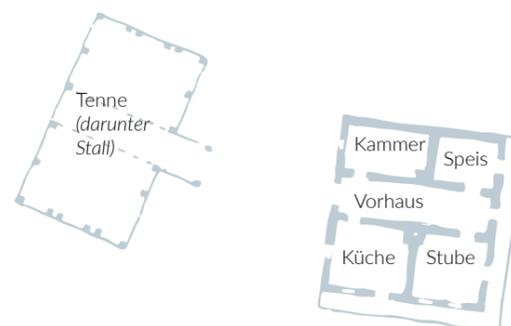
Schematischer Grundriss des Paarhofs
